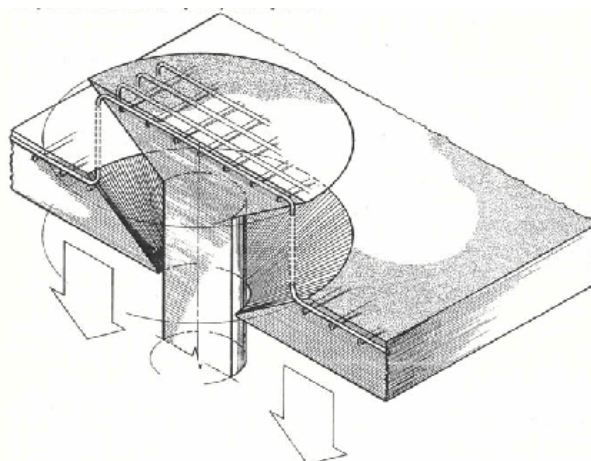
Esquema de rotura por punçoamento numa laje de betão armado [16]
